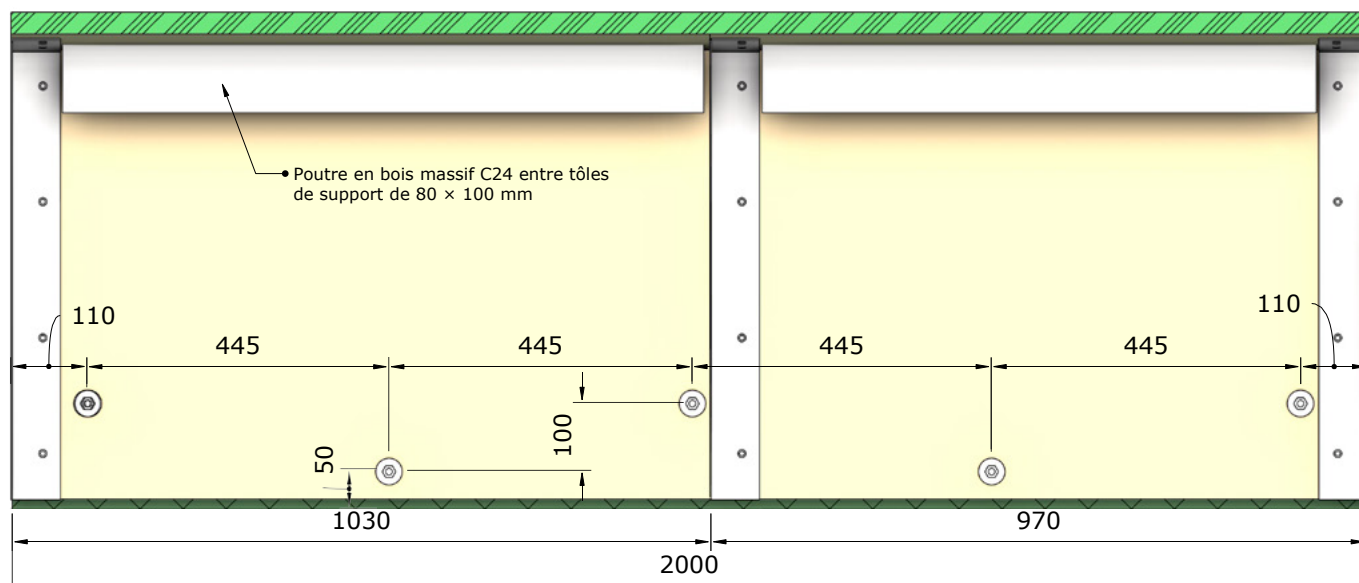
Vue arrière de l'acrotère 4.3, dimensions en mm.
